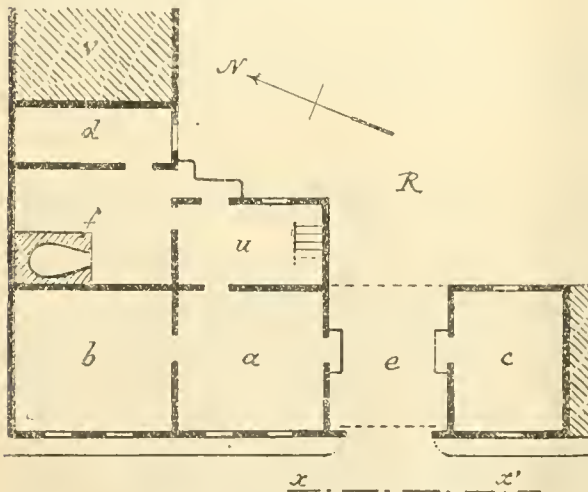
Plan d'une autre habitation rurale de la vallée de la Sambre. (Echelle 0^m.004 par mètre).
